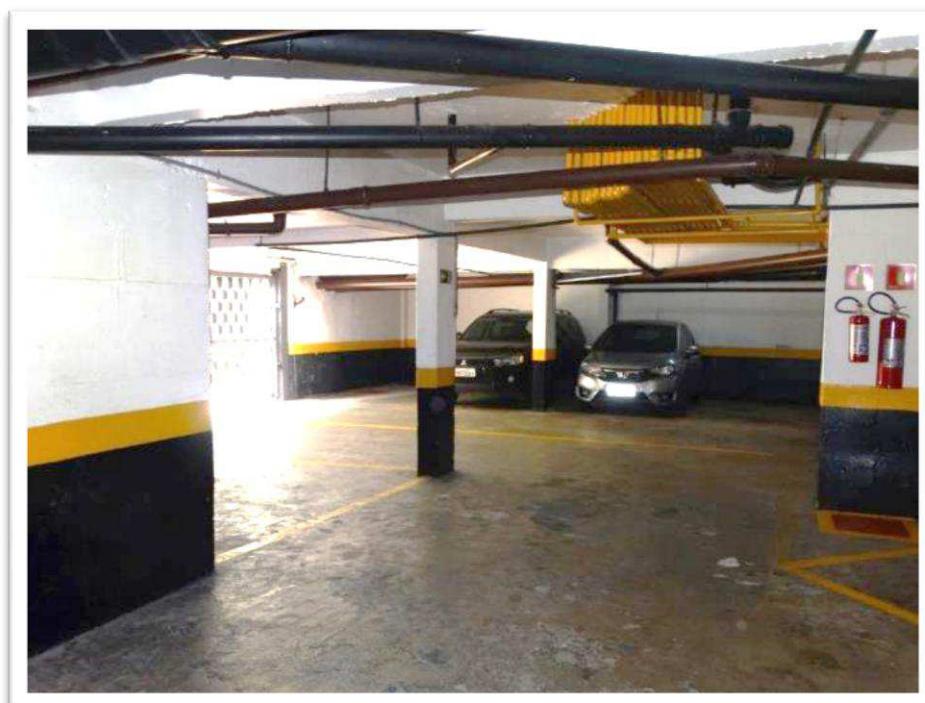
Vista parcial interna do Edifício Via Colomba – Vagas de Garagem no 1º subsolo.
